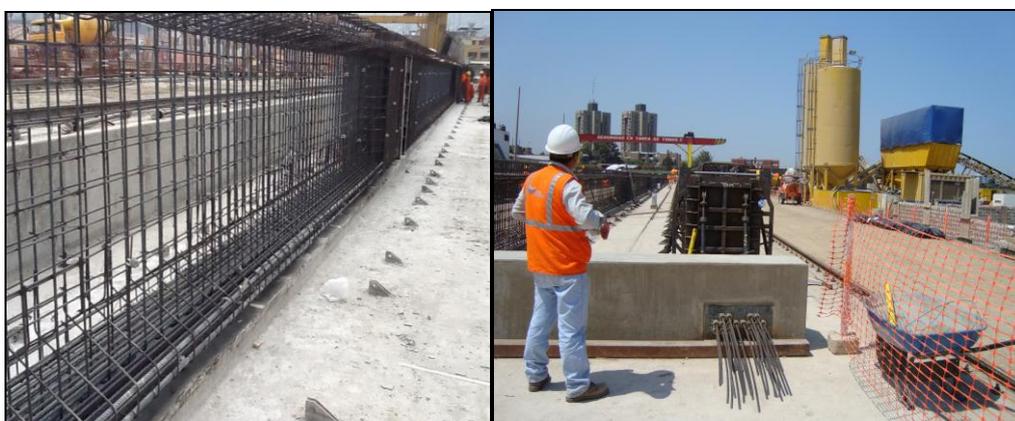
Colocación de torones en armaduras de vigas pretensadas.
